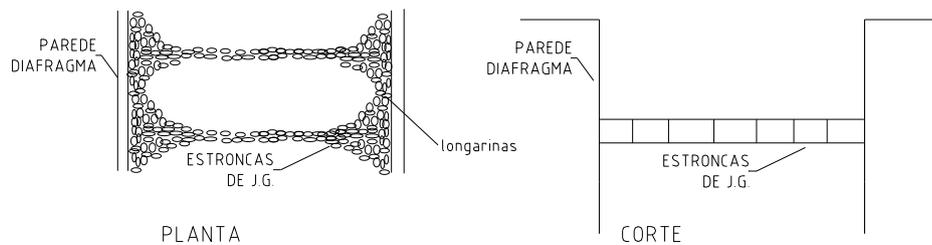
Esquema da obra provisória para a passagem subterrânea da Praça XV, no Rio de Janeiro
